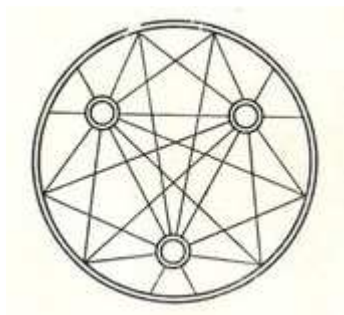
Круглое висячее покрытие павильона с тремя внутренними опорами. План покрытия
